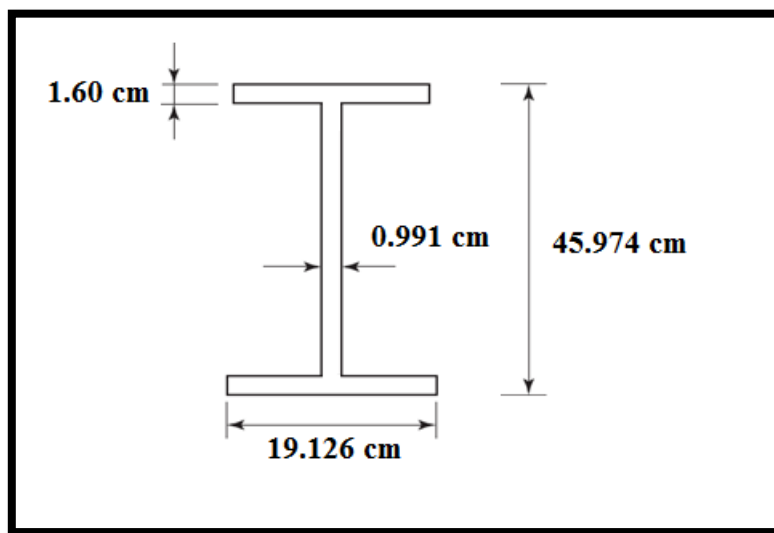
Disposición final del perfil de la viga W18 x 55.
